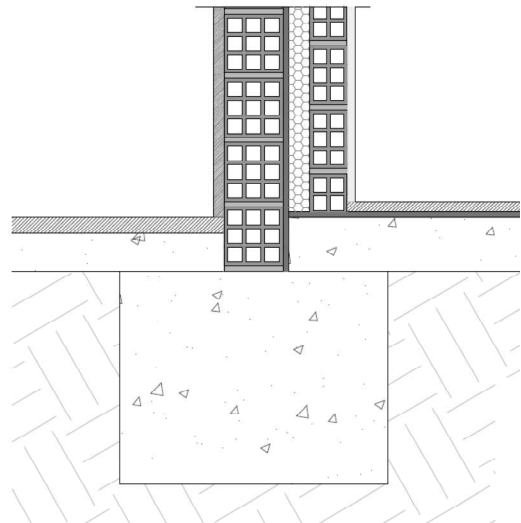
Fachada-Solera. Zona este. Estado rehabilitado.
